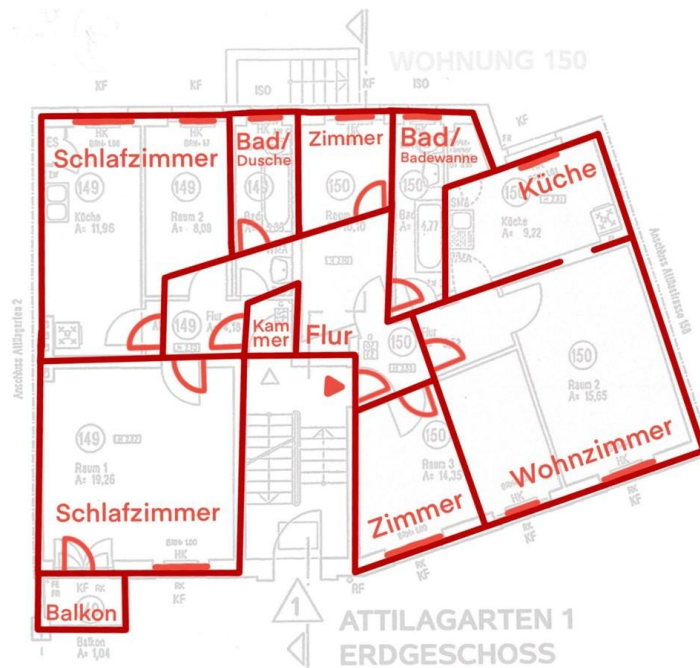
Grundriss Attilagarten 1, EG
